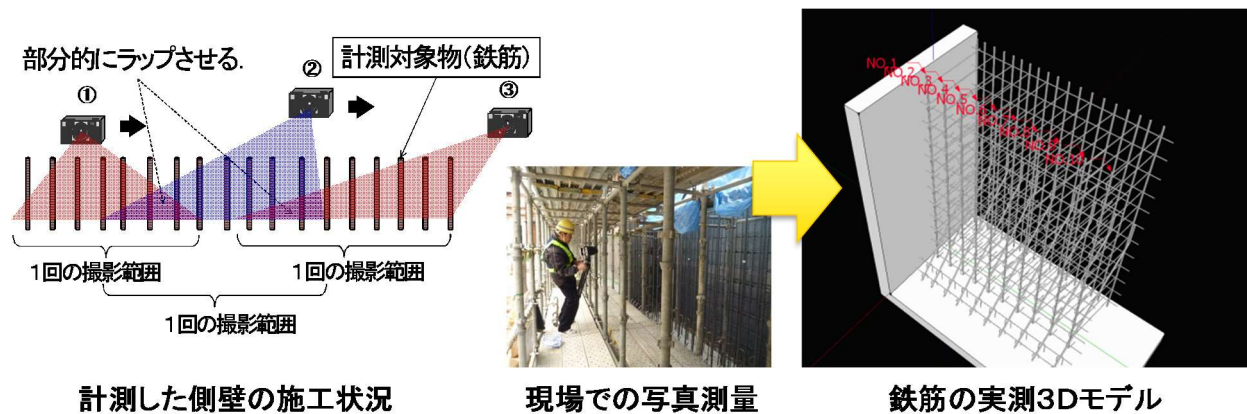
写真計測結果を基に作成した配筋 3 次元モデル
